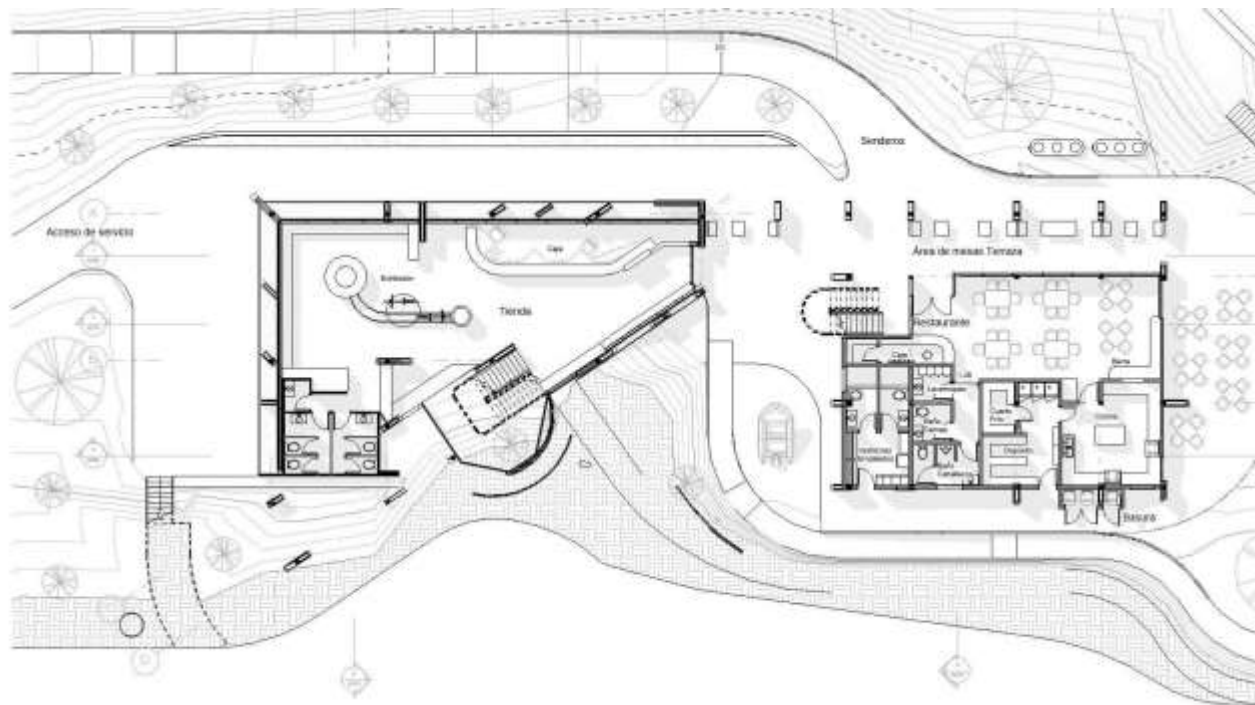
Planta Amoblada Nivel -1 del Edificio Sede.
